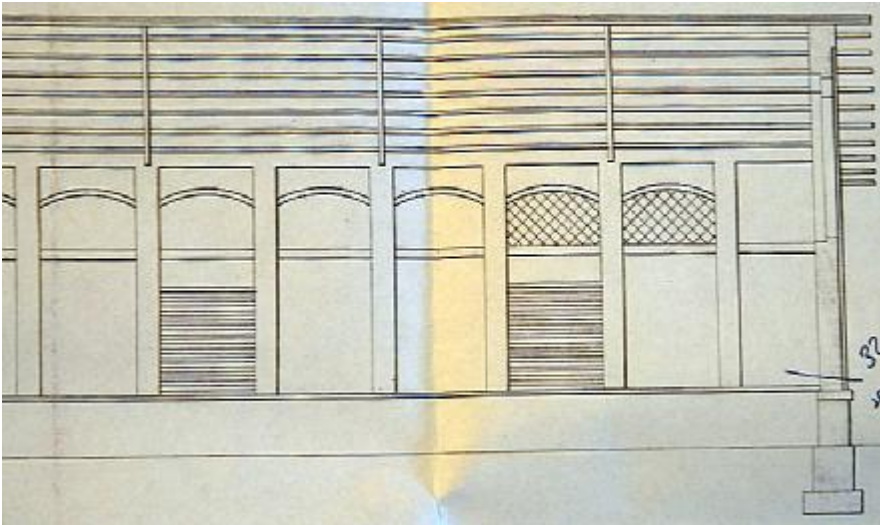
Alzado longitudinal de muelle cubierto. E. de Valencia. (AGA – 2008).
